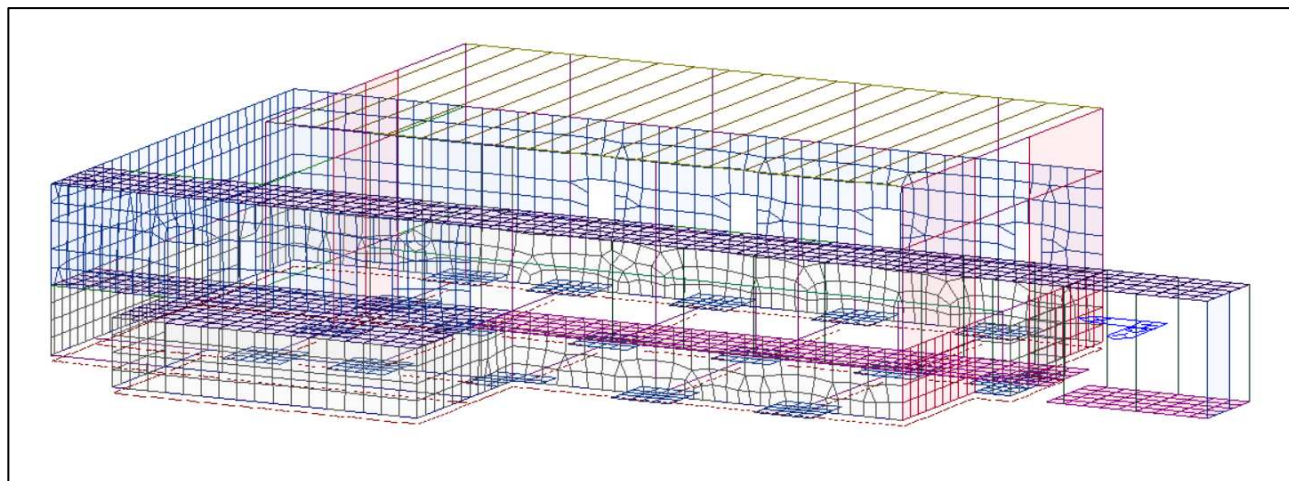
Travi di fondazione su suolo elastico con individuazione delle molle.
